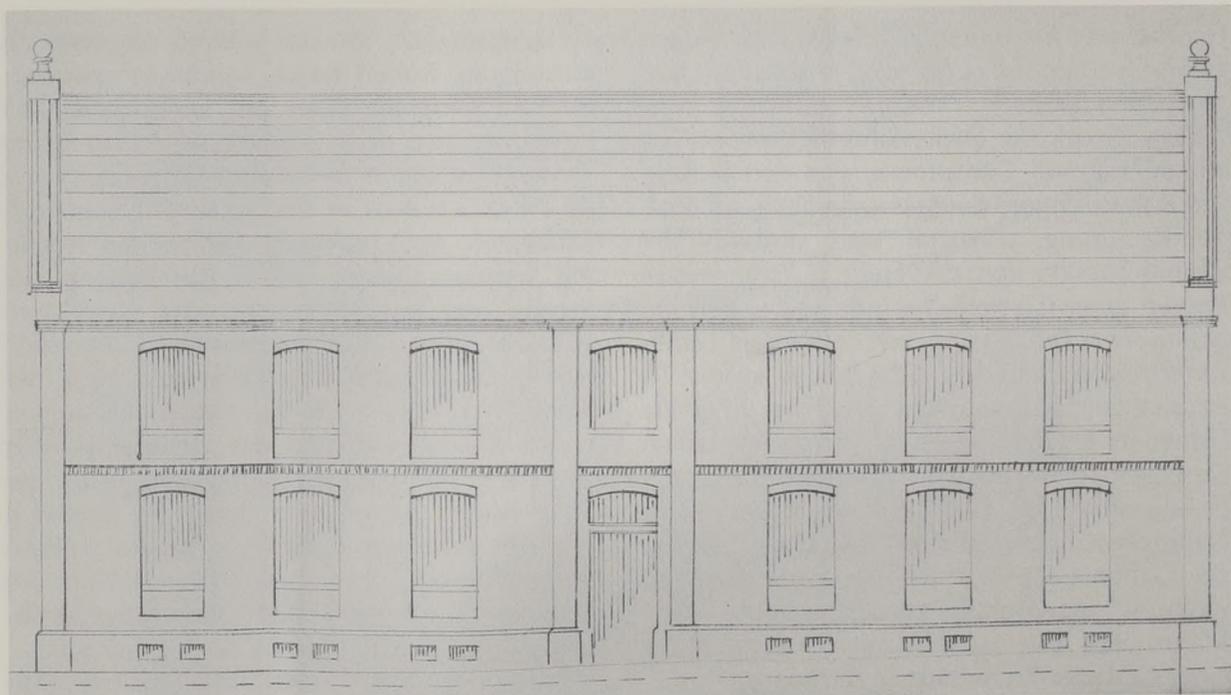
Geplantes „Lehrsaalgebäude“ entlang der Gartenstraße mit Giebel zur Sulzbacher Straße.
